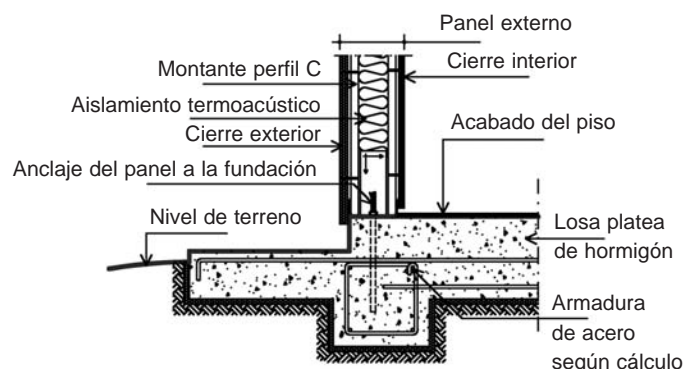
Detalle esquemático de anclaje del panel estructural a una platea de hormigón (adaptado de Consul Steel, 2002).
